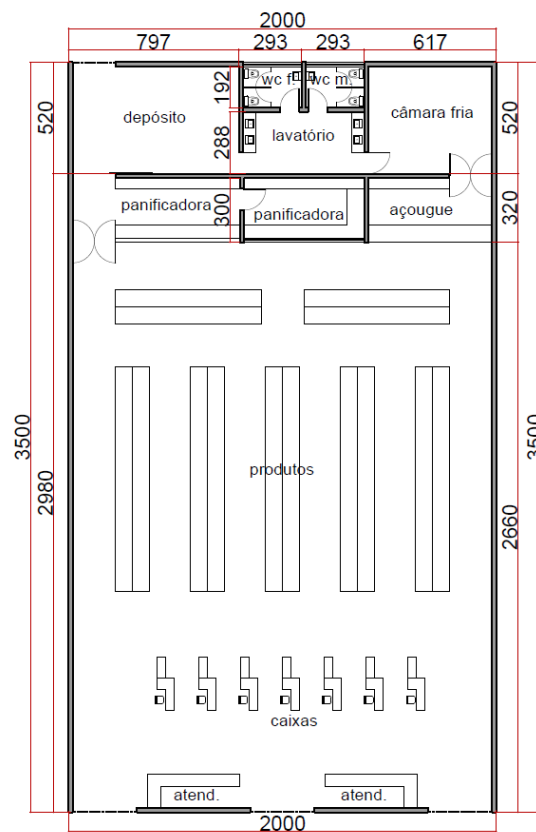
PLANTA ARQUITETÔNICA MINIMERCADO. DIMENSÕES EM CM.
